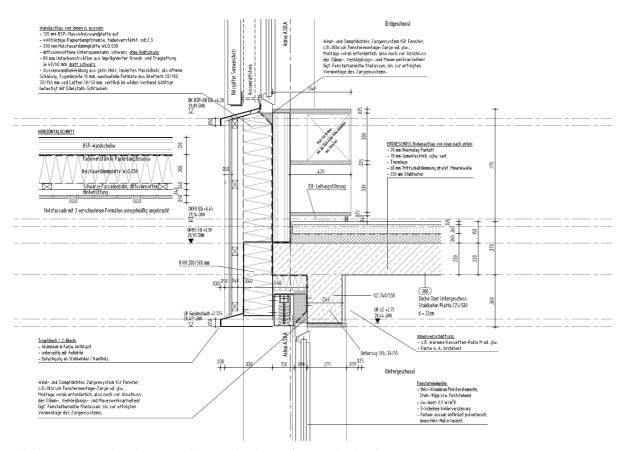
Fassadenschnitt - Anschluss Decke über KG (IBUS Architekten)
